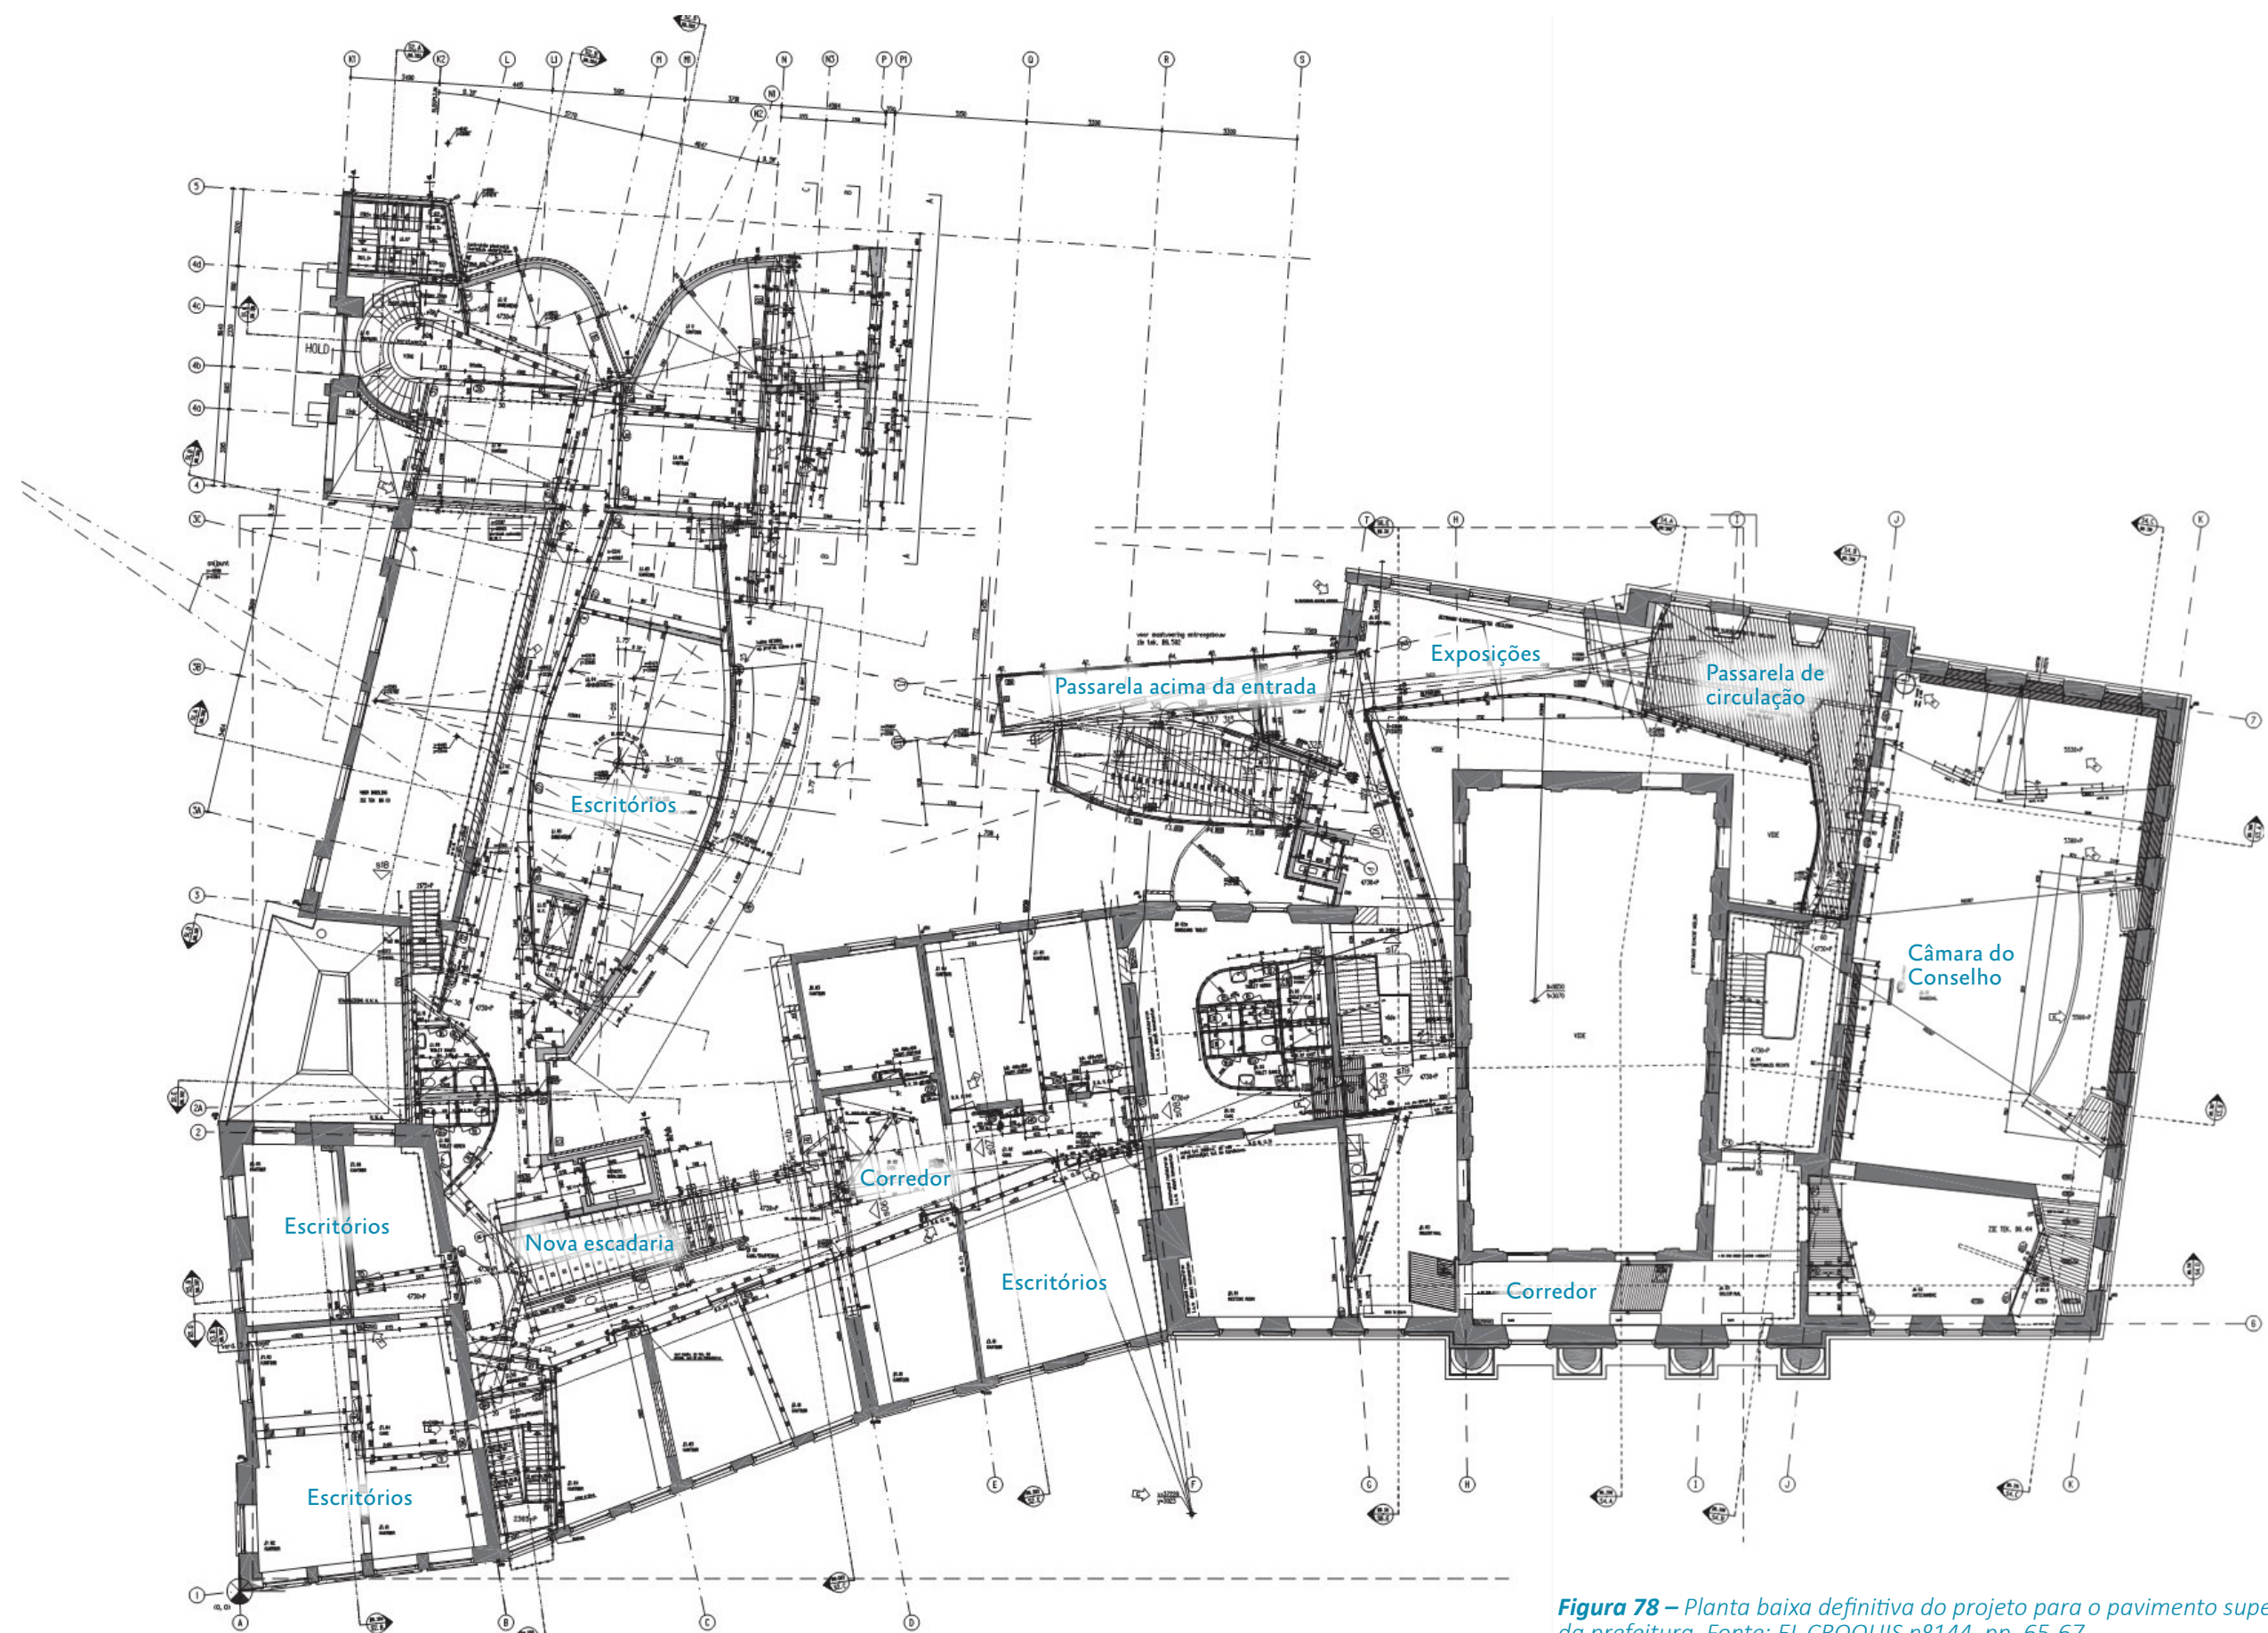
Planta baixa definitiva do projeto para o pavimento superior da prefeitura. Fonte: EL CROQUIS nº144, pp. 65-67.
